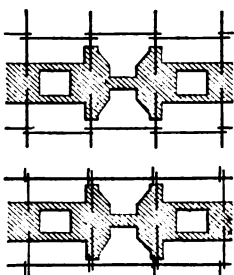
Solives de plancher disposées à l'endroit d'une cheminée.
